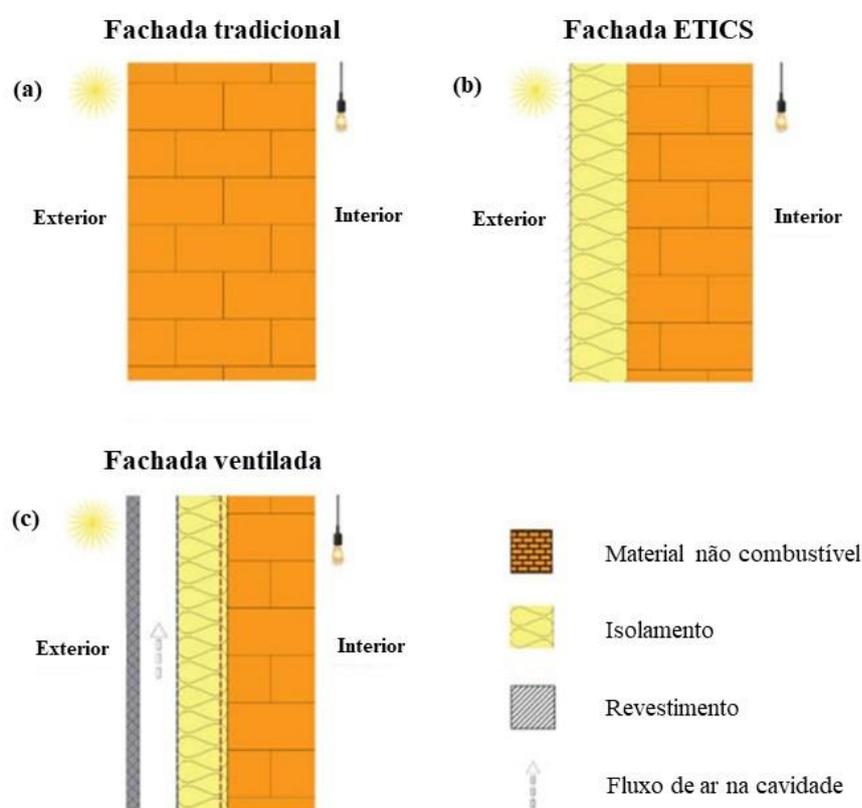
Tipos de fachadas presentes na legislação portuguesa [4].
